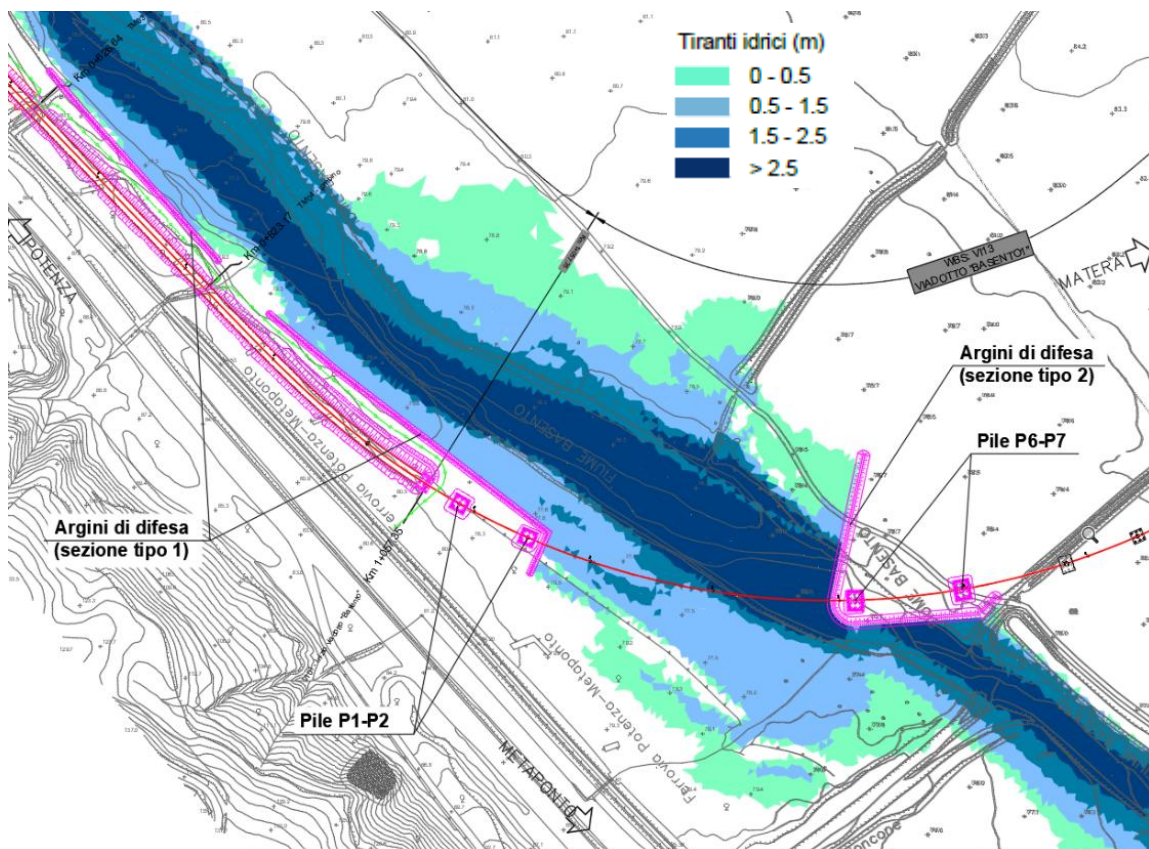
Aree di esondazione nella fase di cantiere 1.
